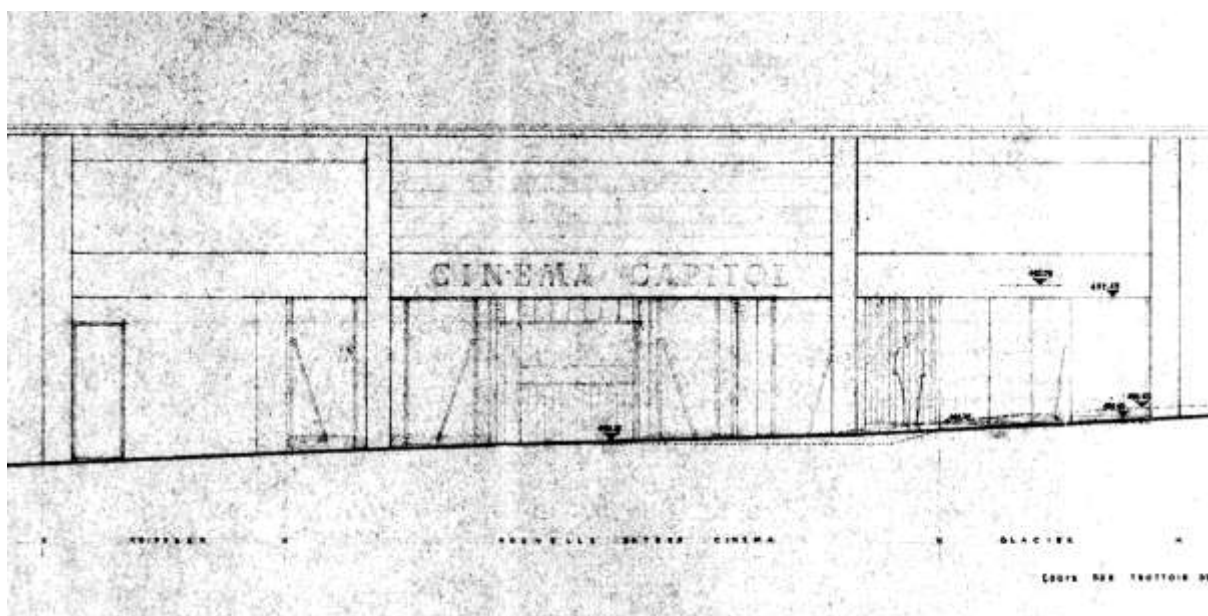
Elévation sur l'avenue du Théâtre, Ferdinand Meyrat, architecte, 1.8.1950 (AVL).
